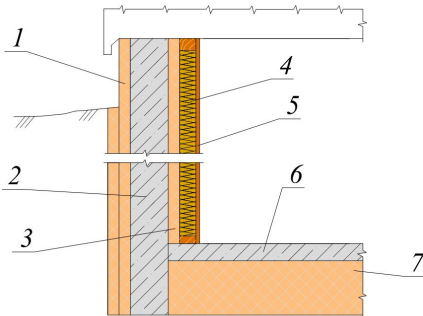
Утепление узла сопряжения пола по грунту с наружным и внутренним утеплением (внутренний слой тепловой изоляции из пенополистирола и минеральной ваты): 1, 3 – пенополистирол; 2 – ж/б стена; 4 – плиты из минеральной ваты; 5 – гипсокартон; 6 – армированная цементно-песчаная стяжка; 7 – два слоя жестких плит пенополистирола
